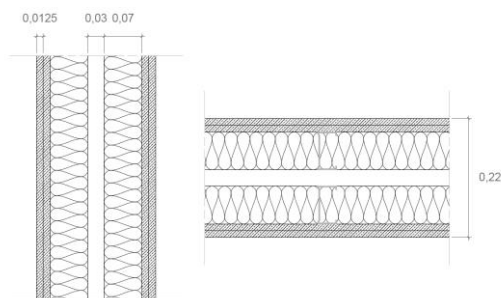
parede divisória dupla em estrutura leve com 220 mm de espessura
